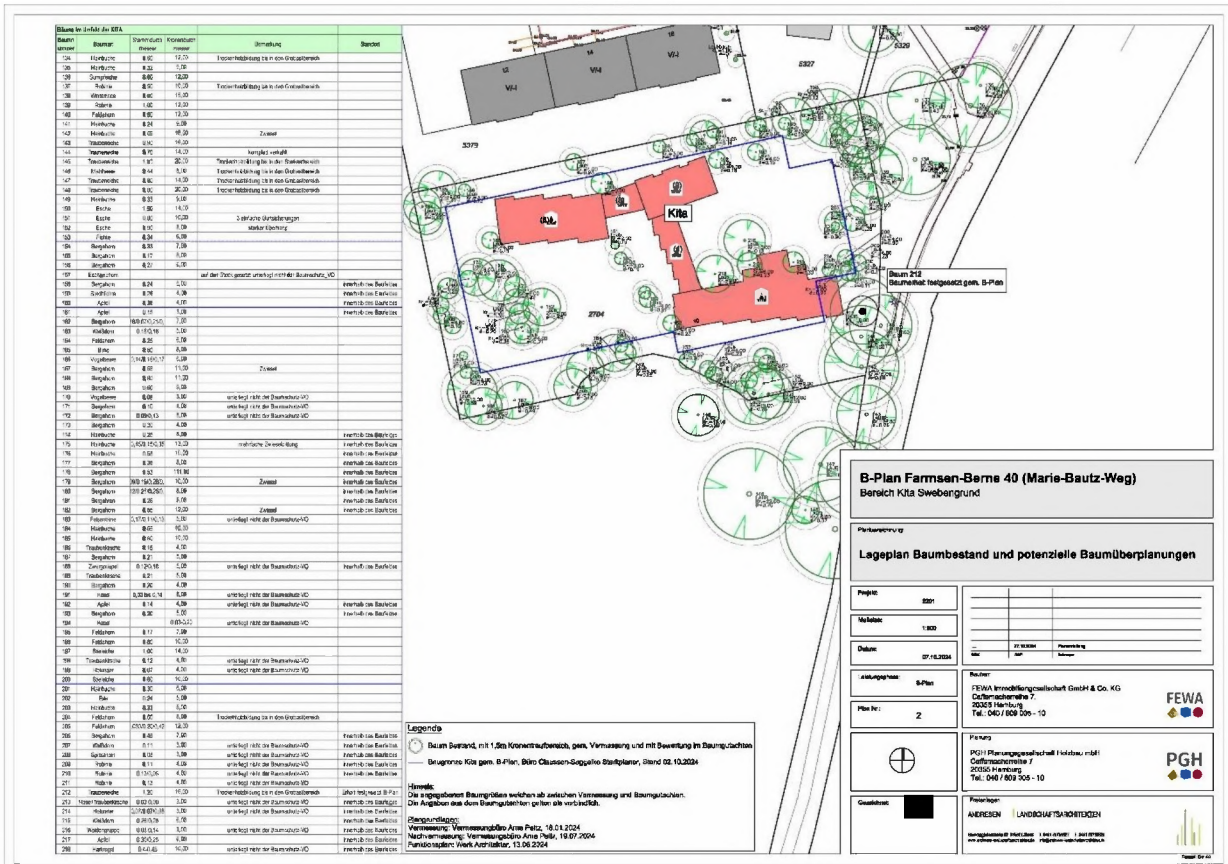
Baumbestand im Bereich Kita Swebengrund (Verkleinerung Lageplan 2, Andresen Landschaftsarchitekten Oktober 2024)
